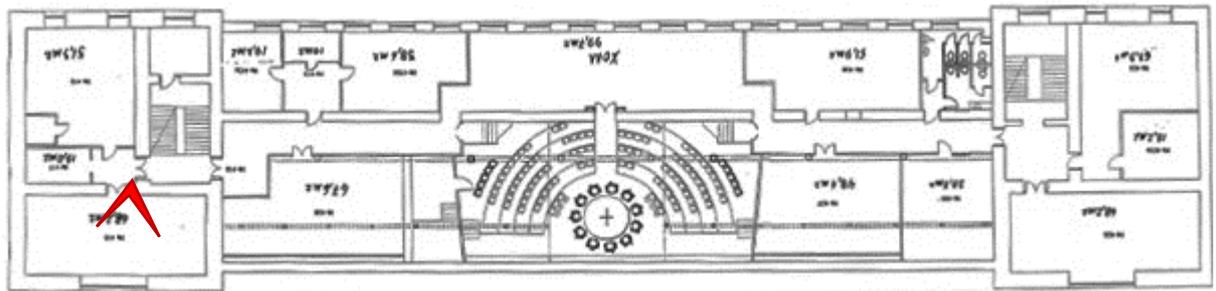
4 этаж. Помещение 11-Н(1-4).
